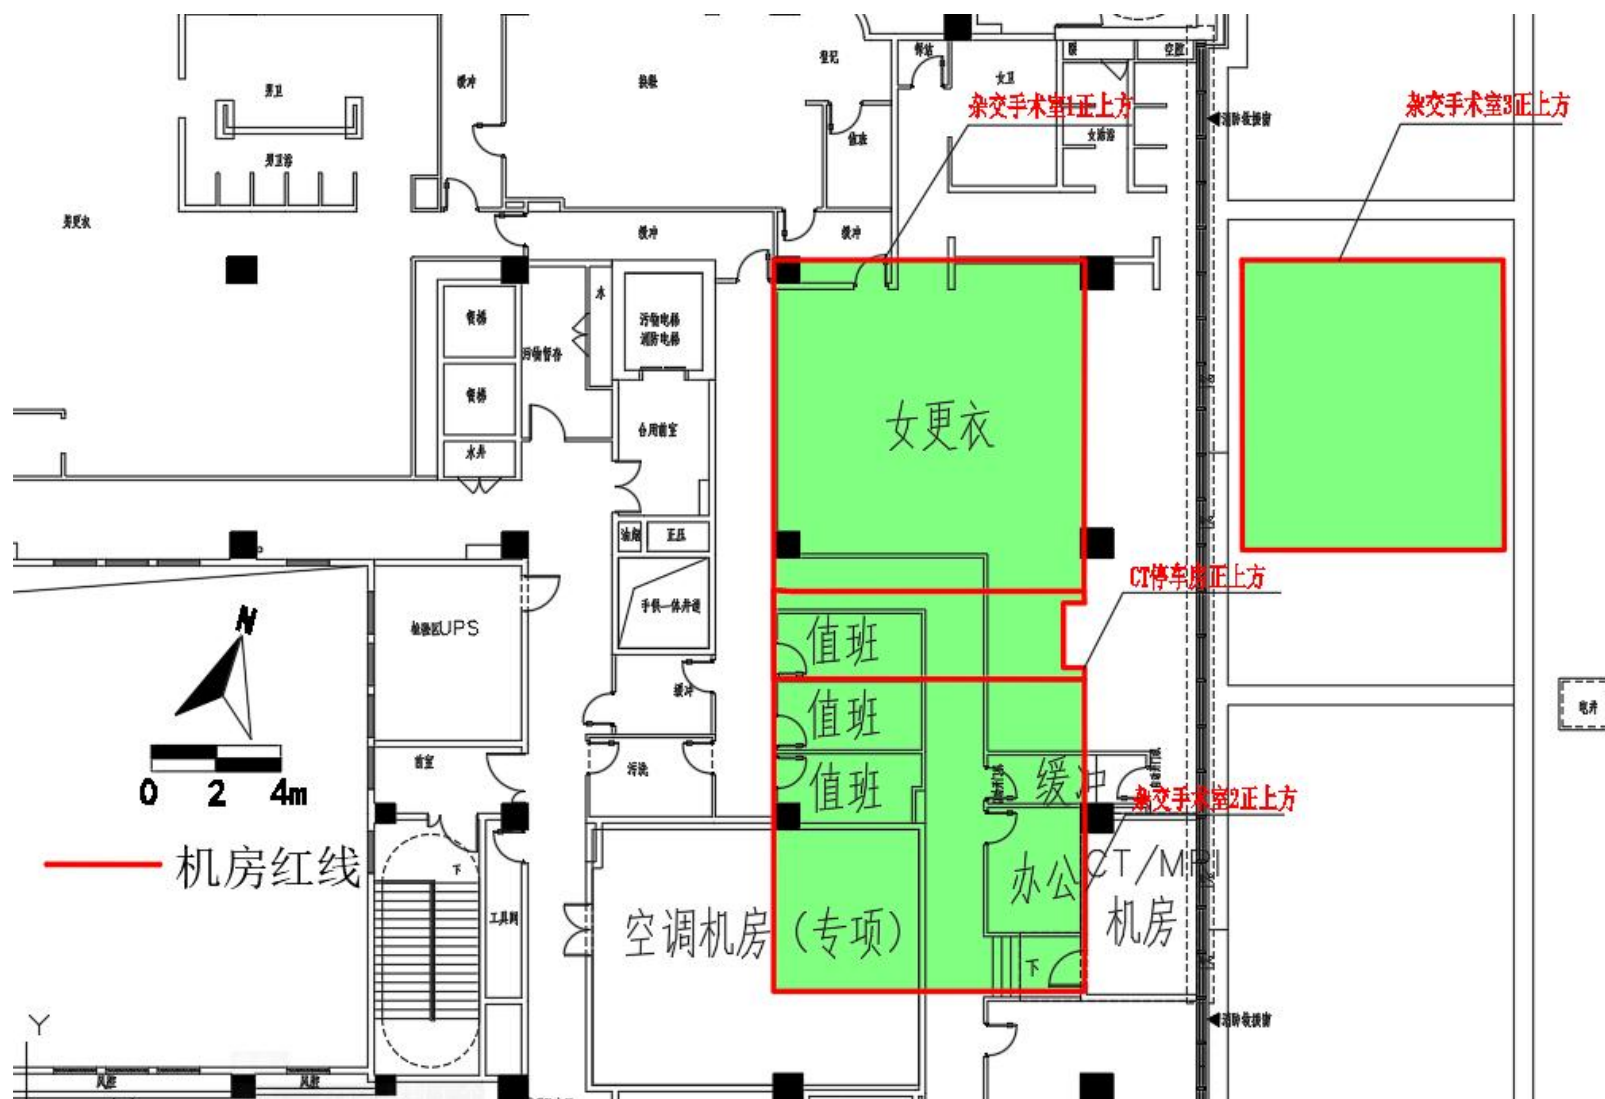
本项目杂交手术室 1、2、3 上方楼层（四层）局部平面布置示意图
